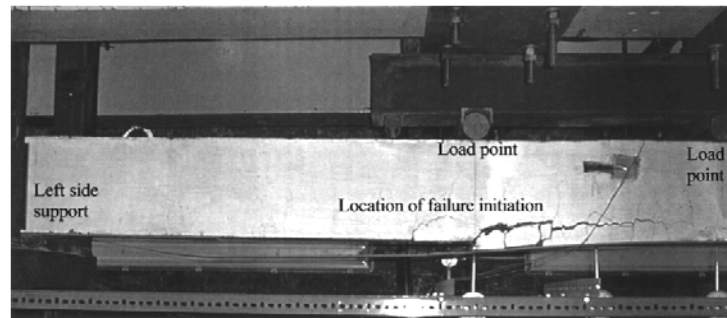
Fallo en las piezas con laminado extendido hasta los apoyos. Fuente: Fanning P. J., et al. (2001)
